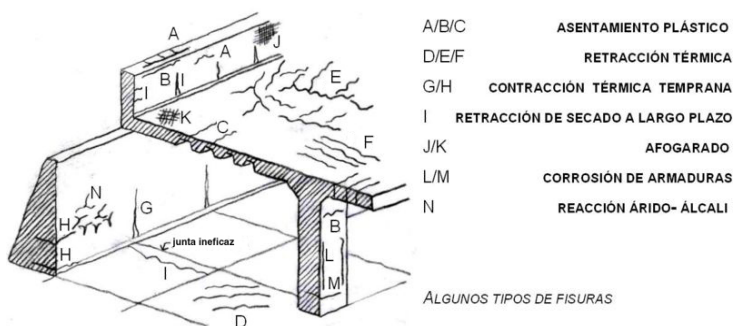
Las causas de la fisuración en el hormigón (Beeby, 1984)
